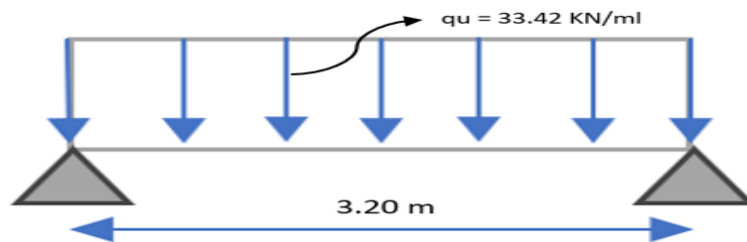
Schéma statique de la poutre palière à l'ELU
